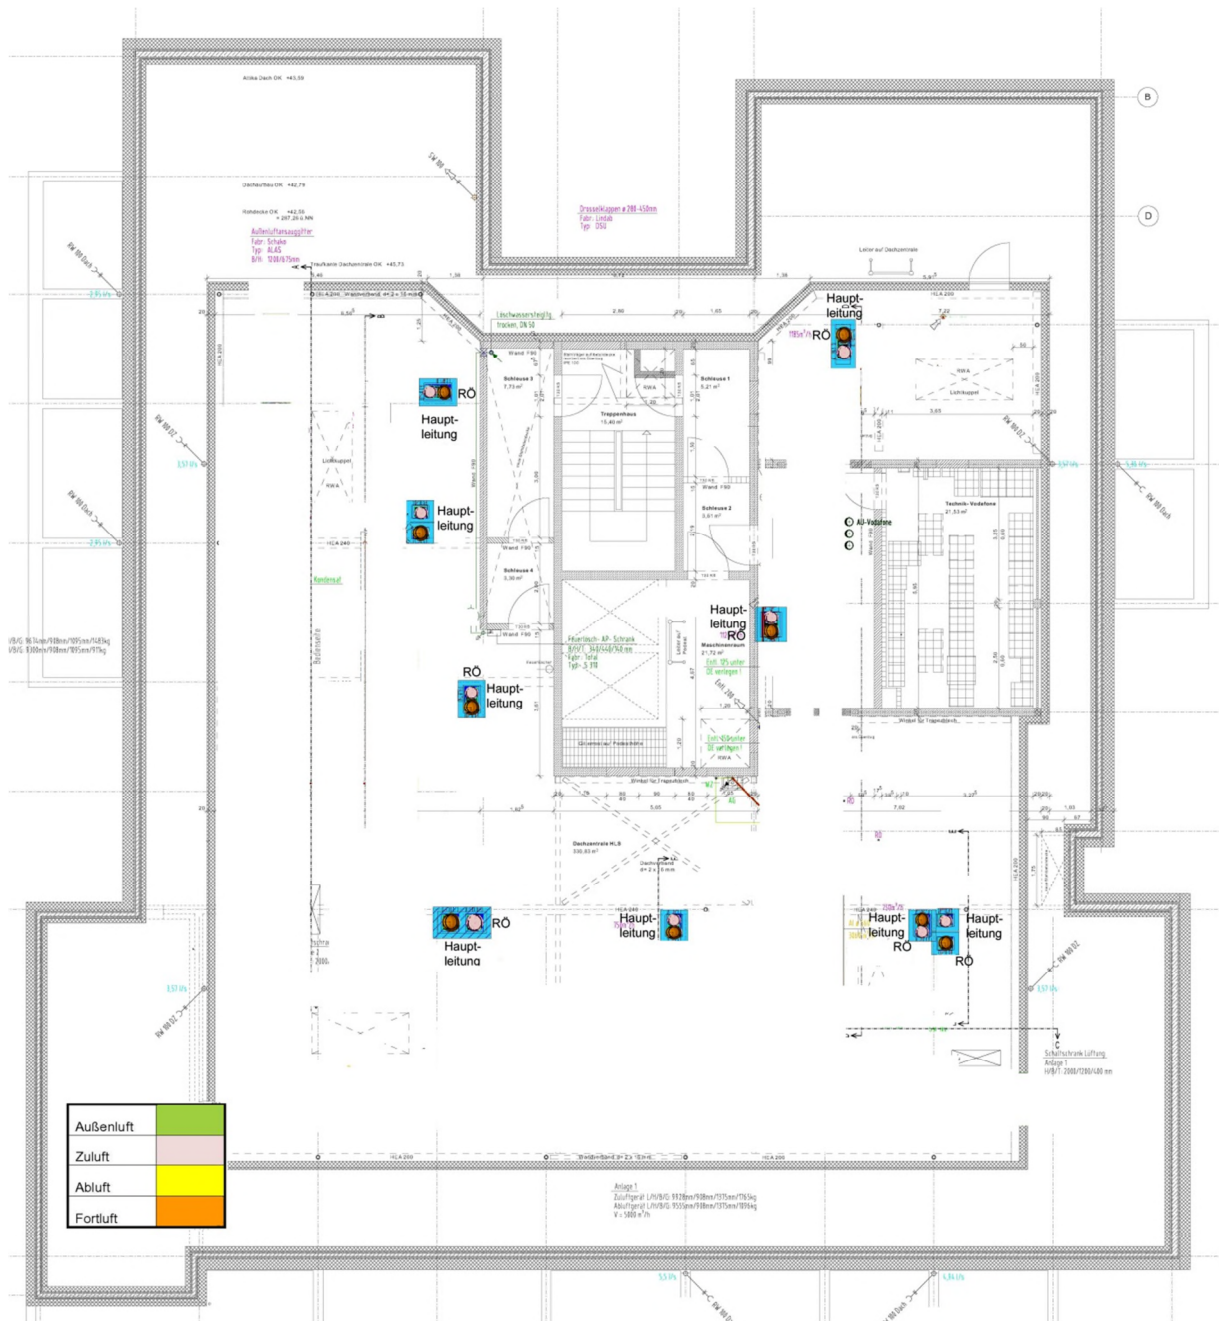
Grundrissbeispiel einer Lüftung für innenliegende Bäder [54]
